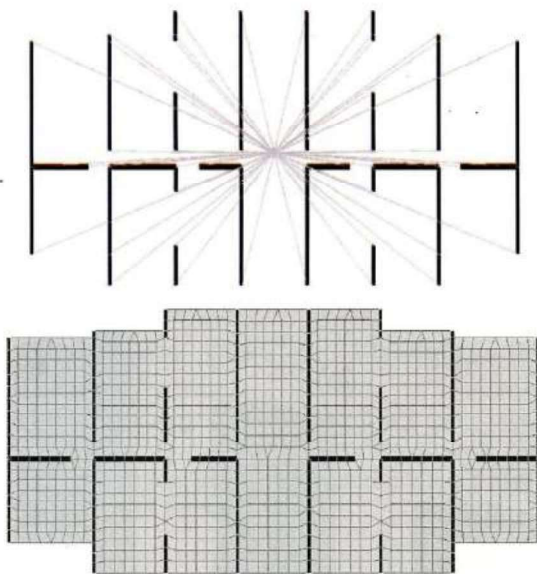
Modélisation plancher rigide - plancher flexible (structure en voile)
